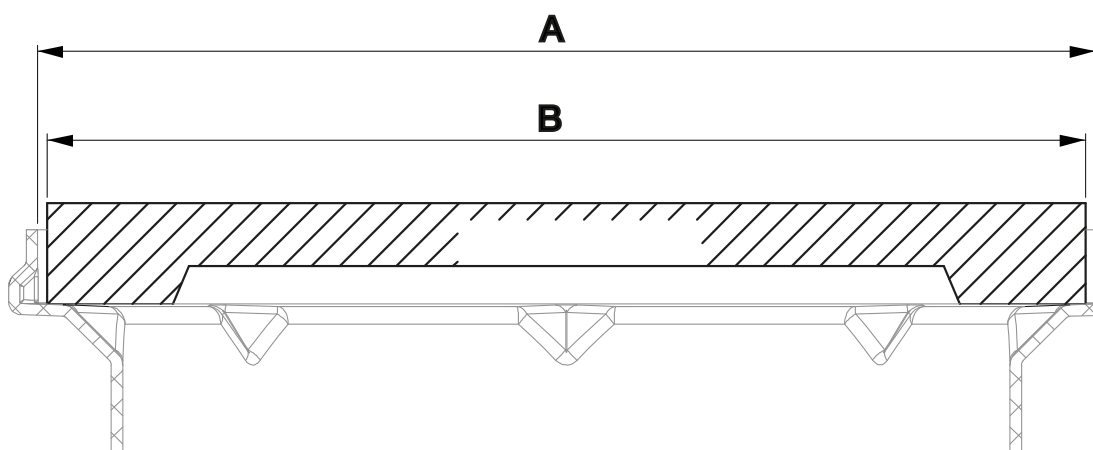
Tapa clase A15 - Dibujo de sección transversal y dimensiones
